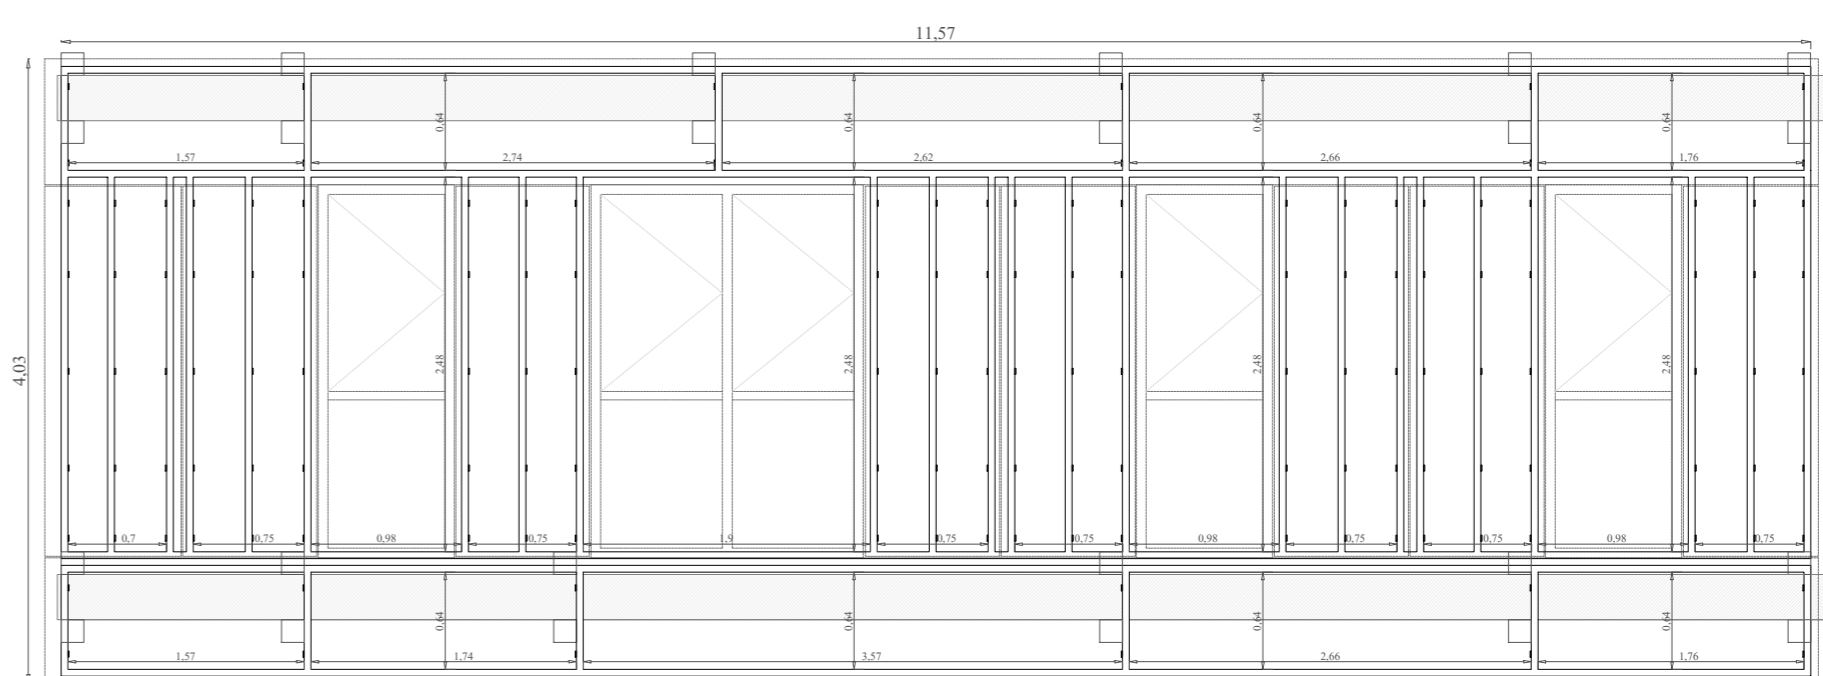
IMAGEN FINAL. Sistema "Stud - frame" para panel GRC.
